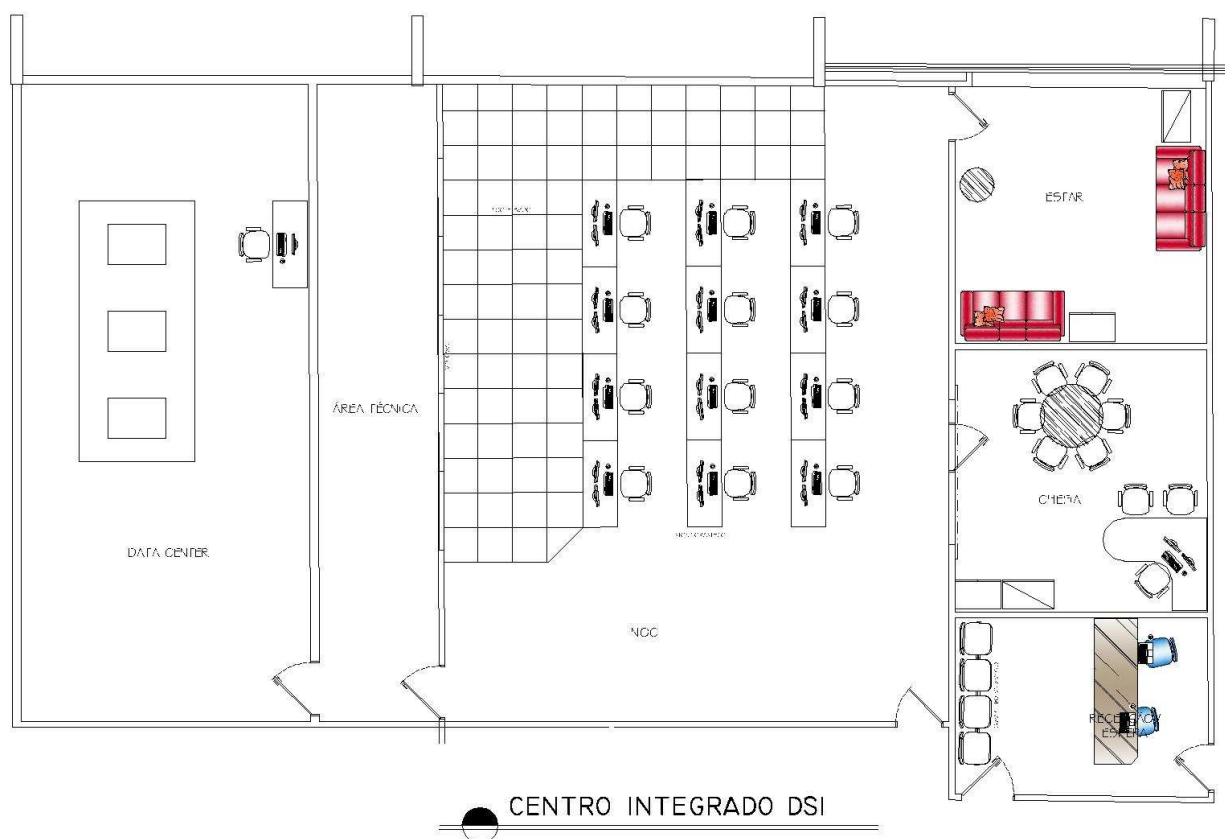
Croqui Layout esquemático da Centro Integrado de Segurança Institucional
